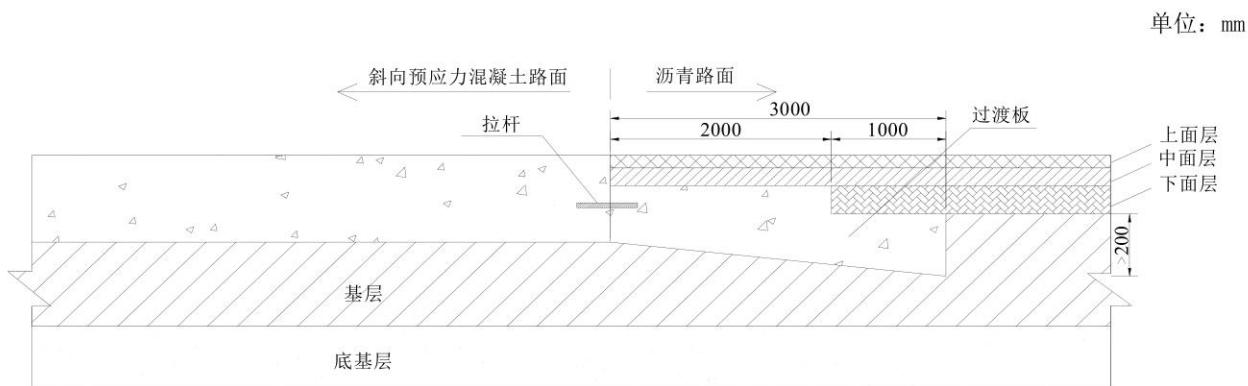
斜向预应力混凝土路面与沥青路面相接段的构造布置
